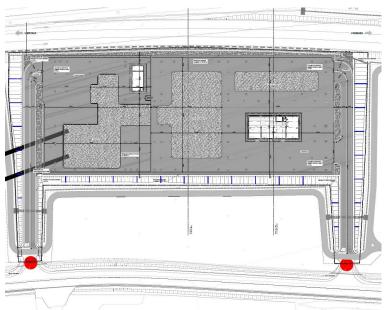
Estratto planimetrico dello stato di progetto – Individuazione dell'area oggetto di intervento con polilinea tratteggiata nera. In base alle indicazioni riportate nel D.G.R.V. 2984/2009, l'area di interesse risulta così suddivisa in termini di permeabilità del suolo:
